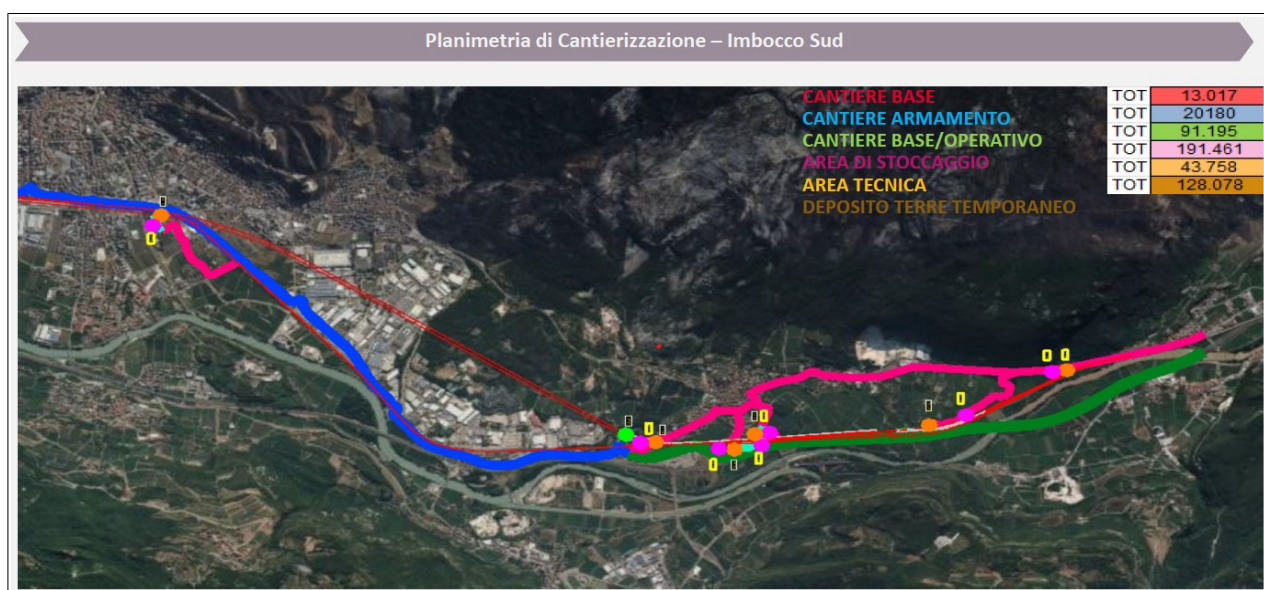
Planimetria di cantierizzazione imbocco sud (percorsi e quantificazioni aree di cantiere)
